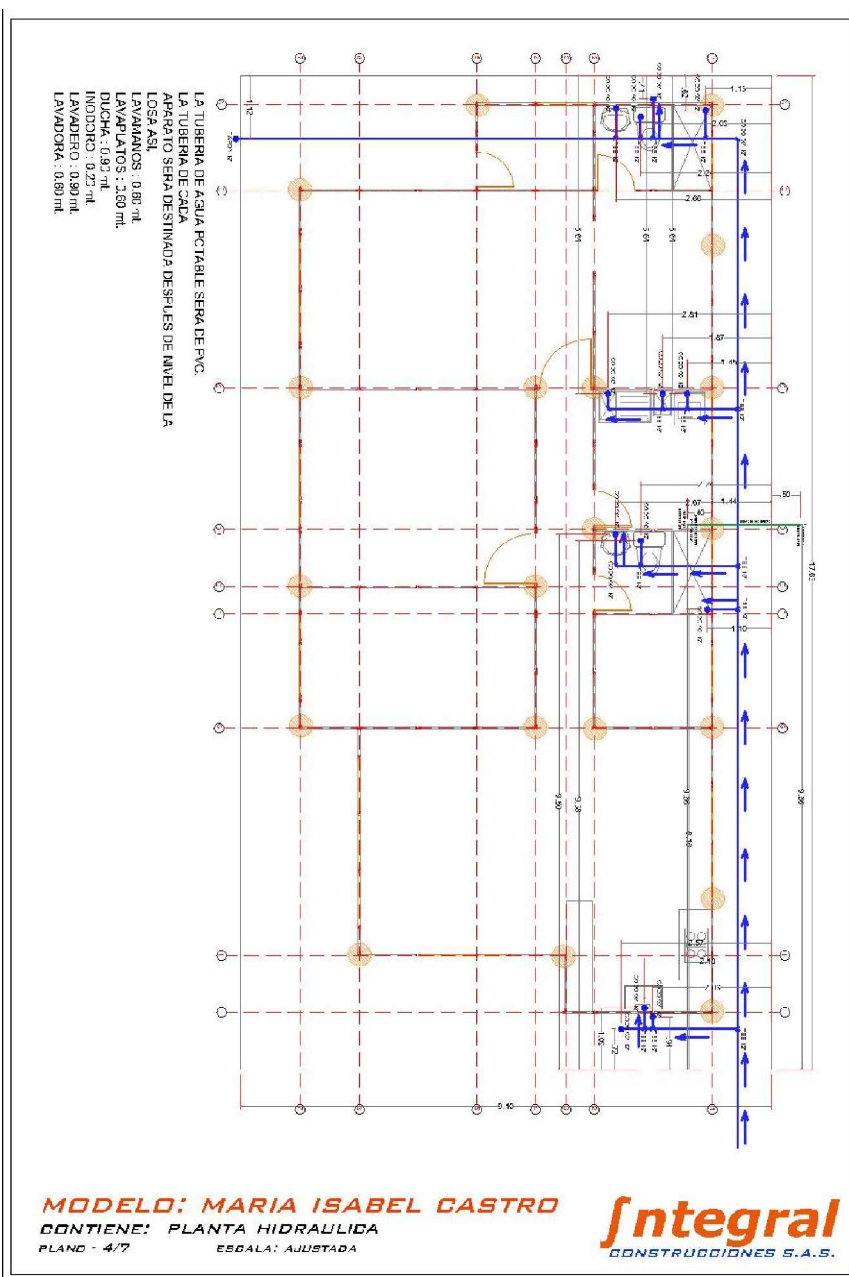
Plano redes sanitarias vivienda María Isabel Castro
